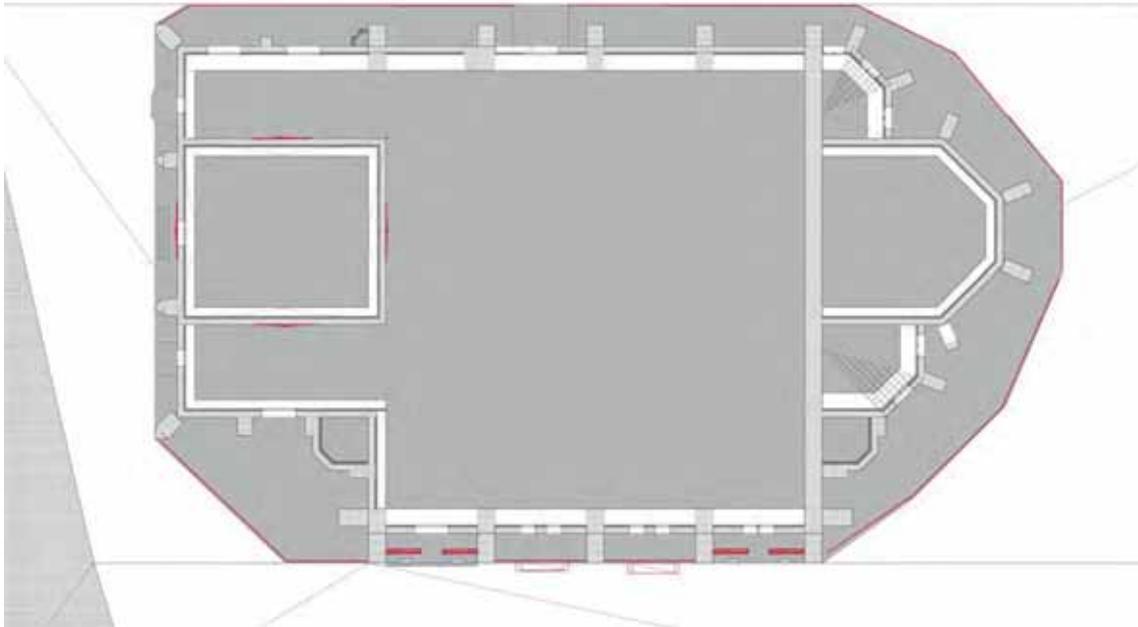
Grundriss ArchiCAD Zeichnung (eigene Abbildung)
